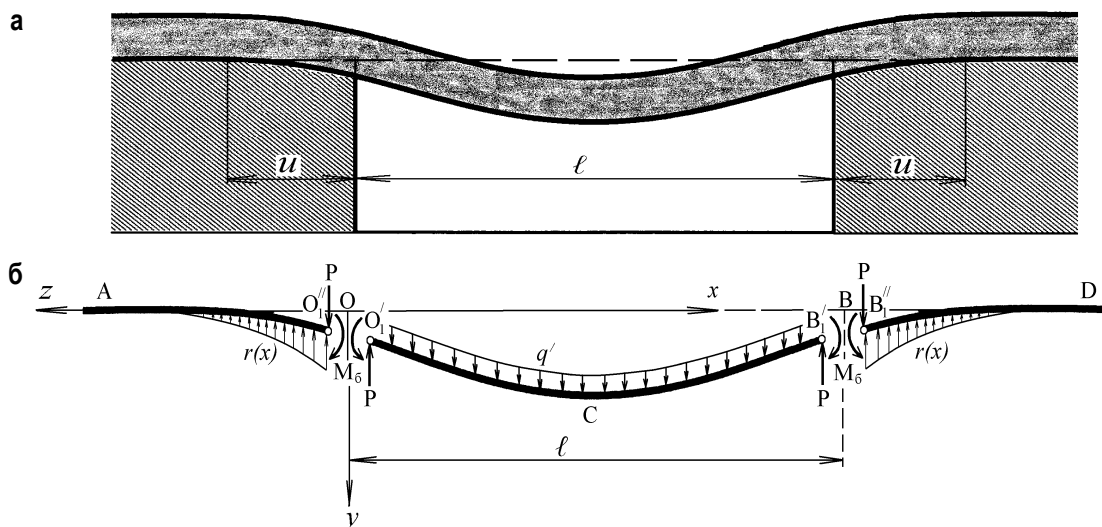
Влияние податливости опор на характер деформирования кровли подготовительной выработки: а – общий вид; б – расчетная схема
